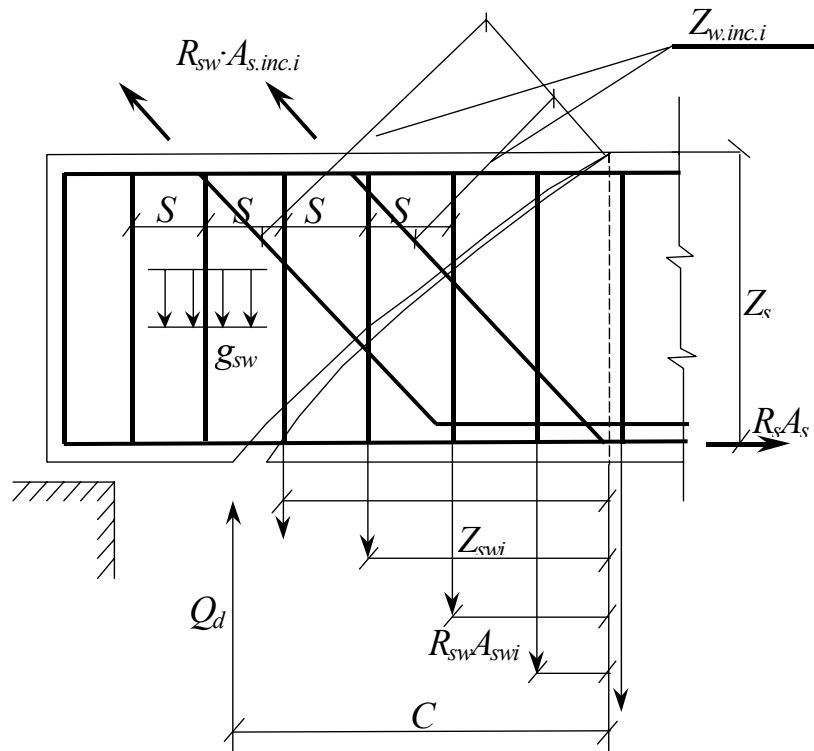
Розрахункова схема зусиль за похилими перерізами
